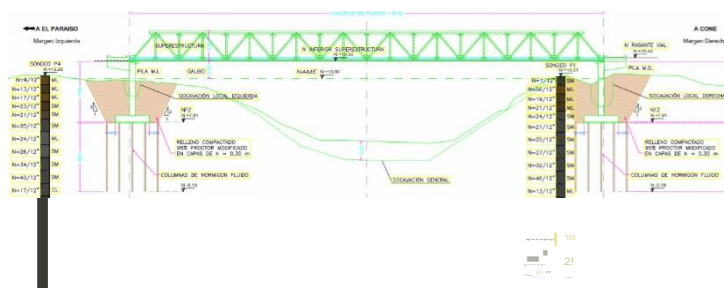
Sección longitudinal del Puente Peatonal sectores Cone - Chobo
